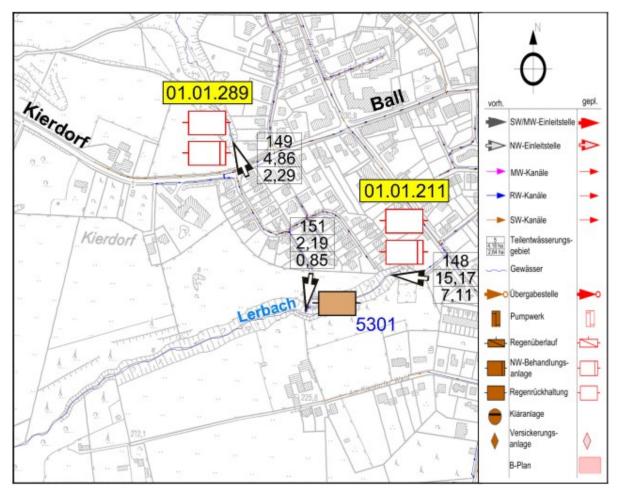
Auszug aus Lageplan (unmaßstäbliche Darstellung)
